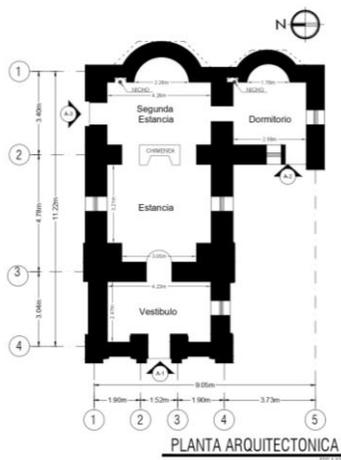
Planta arquitectónica del estado actual de la Casa de Éfeso. (Aguilar, 2019)
